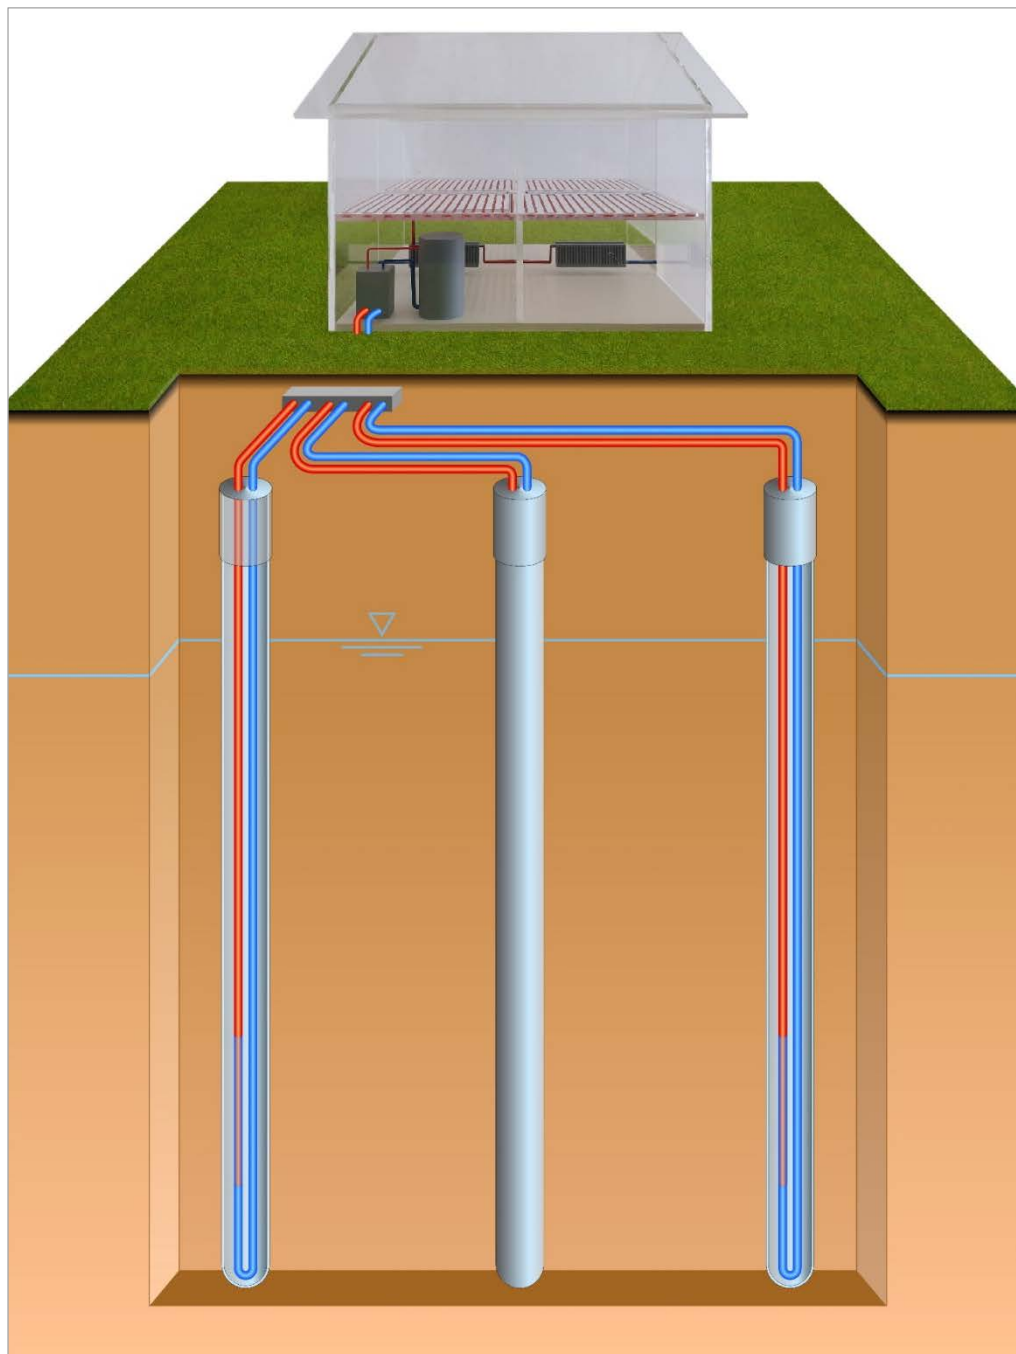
Schematische Darstellung eines Systemhauses mit drei Erdwärmesonden. Die mit einem Verfüllbaustoff umschlossenen Erdwärmesonden sind zur Veranschaulichung teilweise halbtransparent dargestellt. Der Grundwasserspiegel ist als blaue Linie im Untergrund eingezeichnet.
